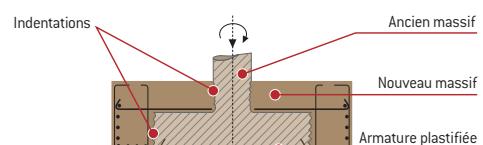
Fondations : renforcement avec surépaisseur de la semelle [coupe transversale]
